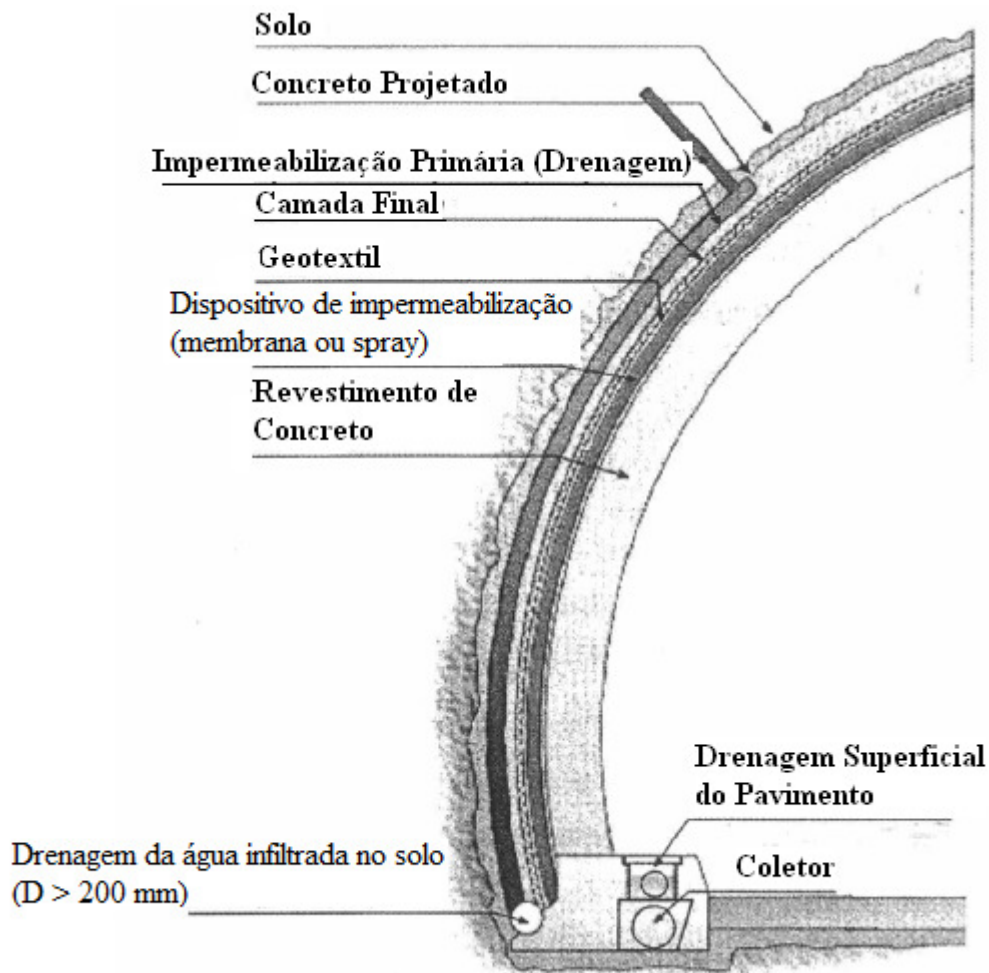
Seção tipo do sistema de drenagem e impermeabilização.
